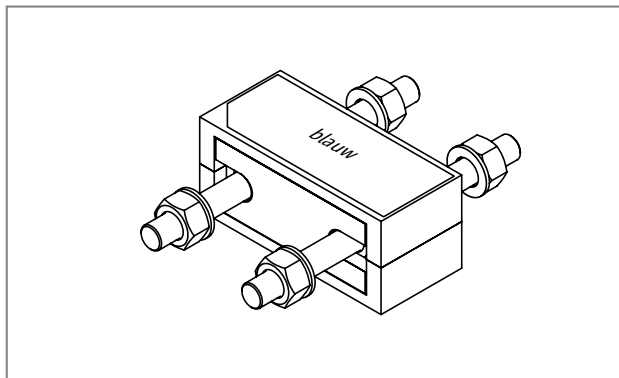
Schöck Isokorb® T type S-V-D16: Vooraanzicht
